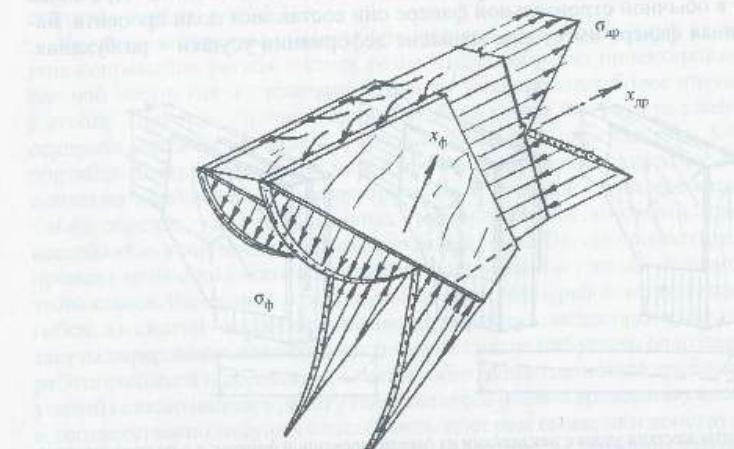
Схемы силовых потоков в рамном узле с накладками из бакелитированной фанеры
